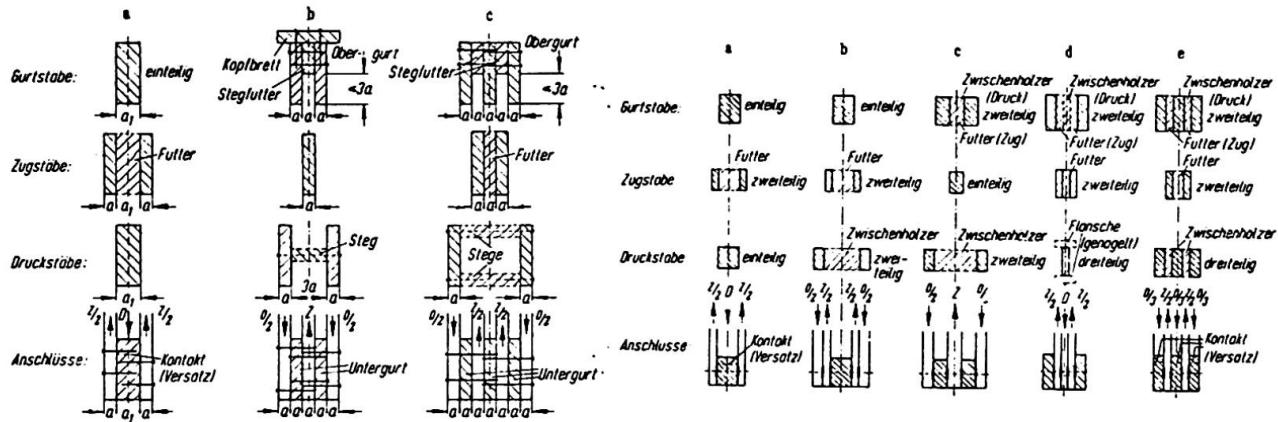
Mehrteilige Querschnitte ein- und mehrteiliger Stäbe für Nagelanschlüsse
